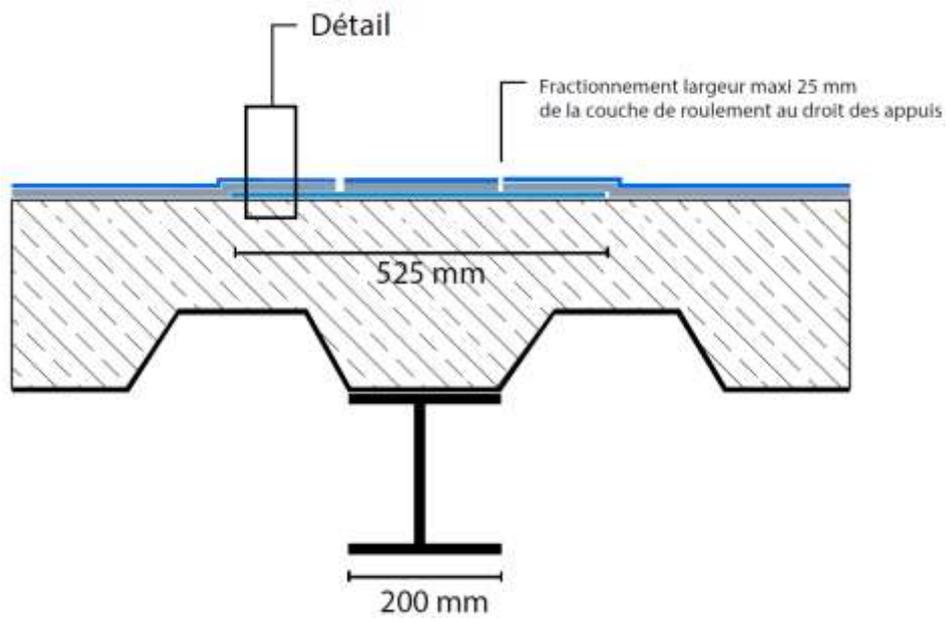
Traitement des appuis longitudinaux dans le cas des planchers à bacs collaborants (tout appui dans le cas de plancher de type D avec dalle de compression)
